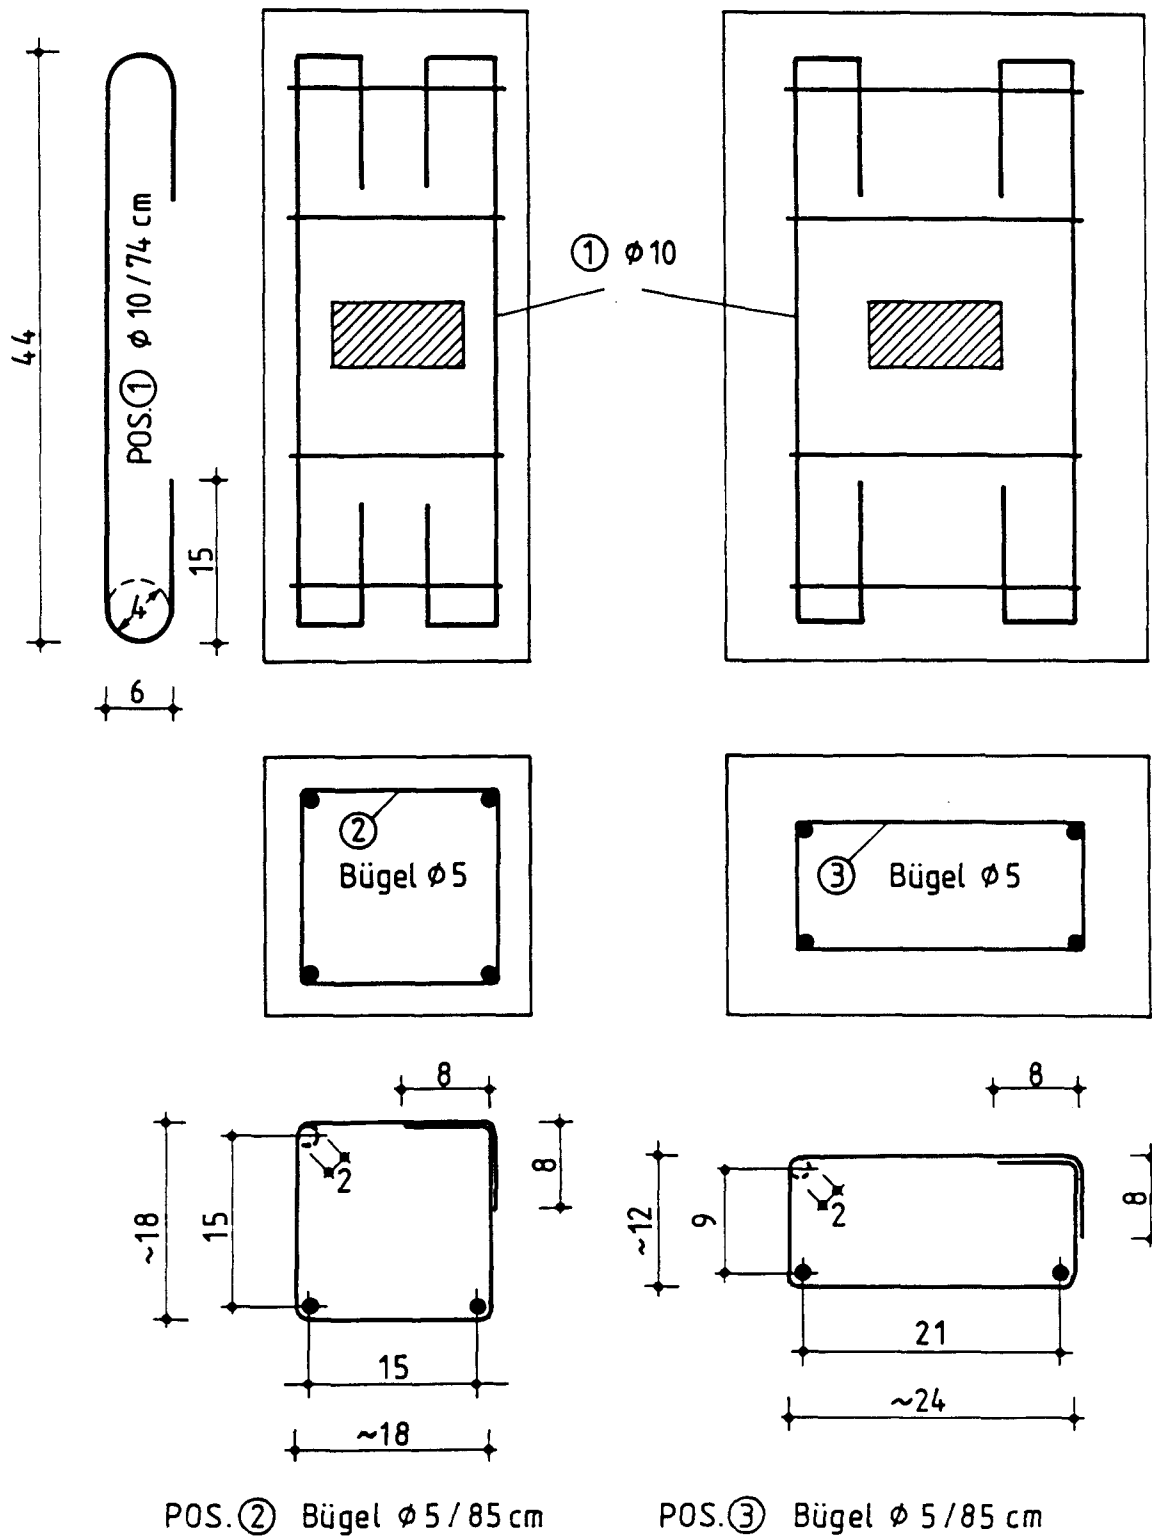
Bewehrungsplan der Stahlbetonkörper mit eingepprägten Trennrissen.
